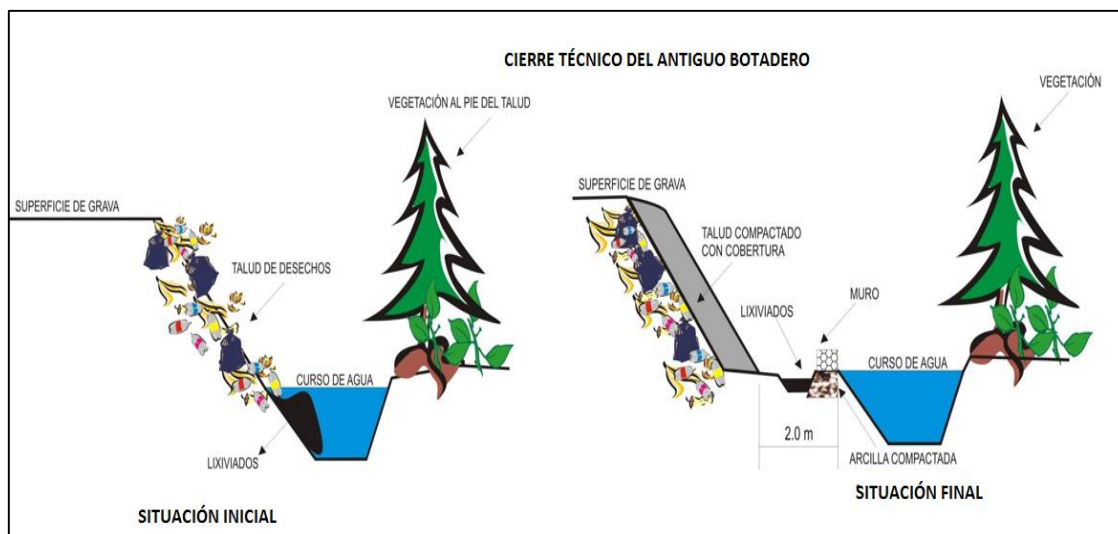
CIERRE TÉCNICO DEL ANTIGUO BOTADERO DEL CANTÓN MEJÍA
